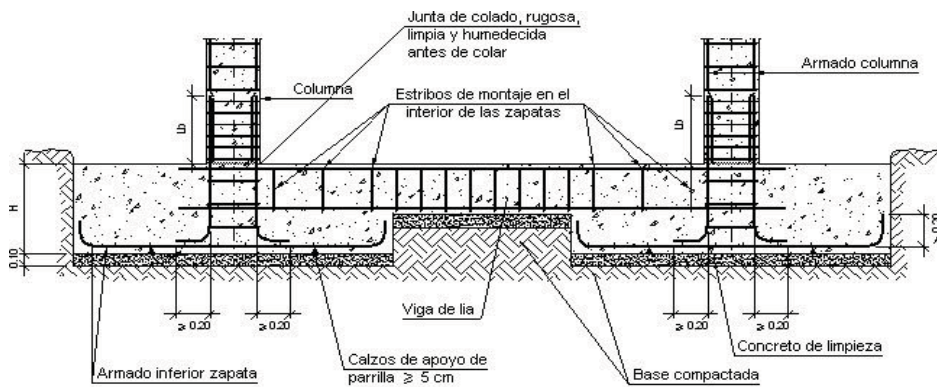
Detalle en corte de zapatas aisladas unidas por medio de trabe de liga.
